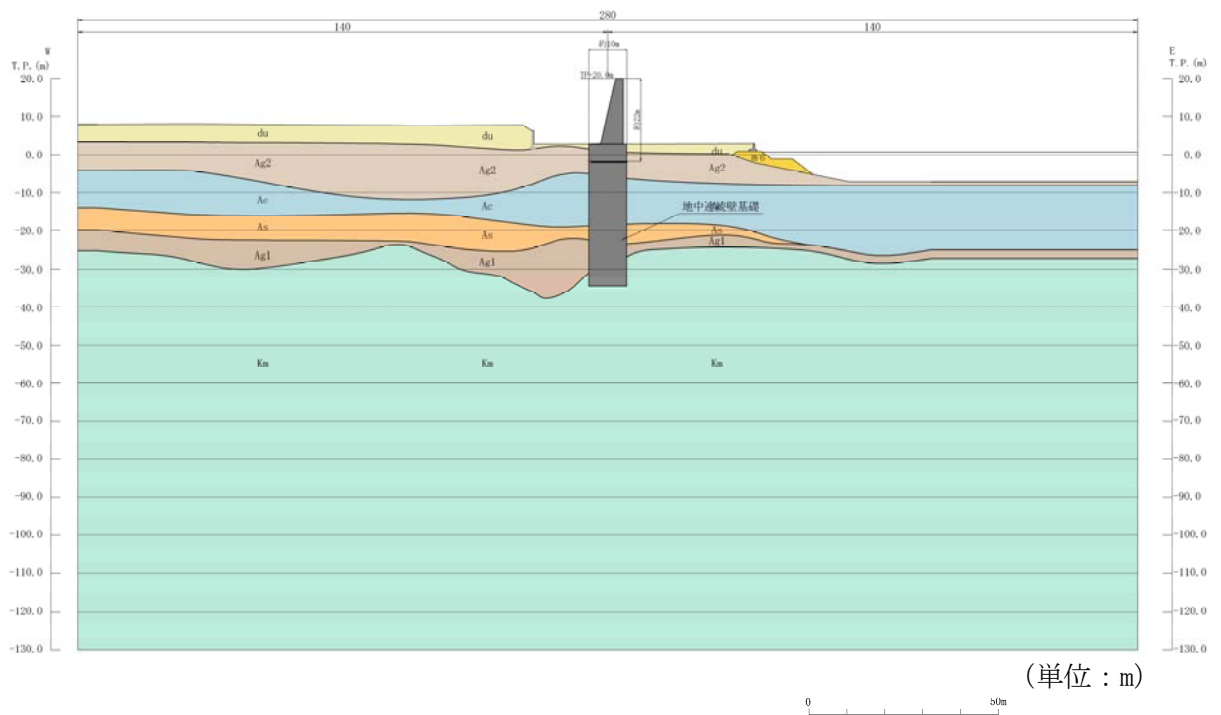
(4) 鉄筋コンクリート防潮壁 断面図(D-D断面)
